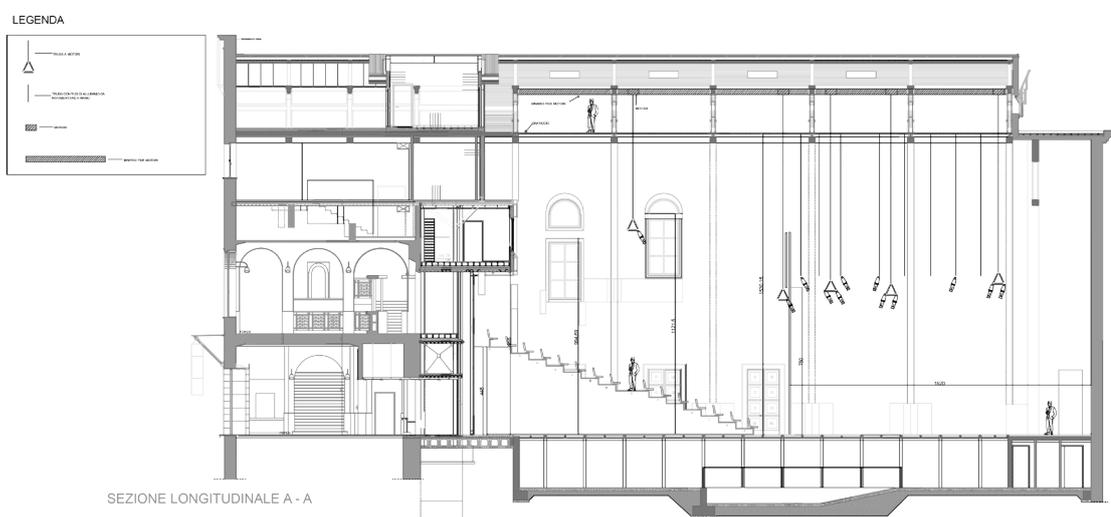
Sezione del progetto di ristrutturazione della galleria, 2006. Fonte: Sito internet Teatro Astra TPE (Teatro Piemonte Europa)
